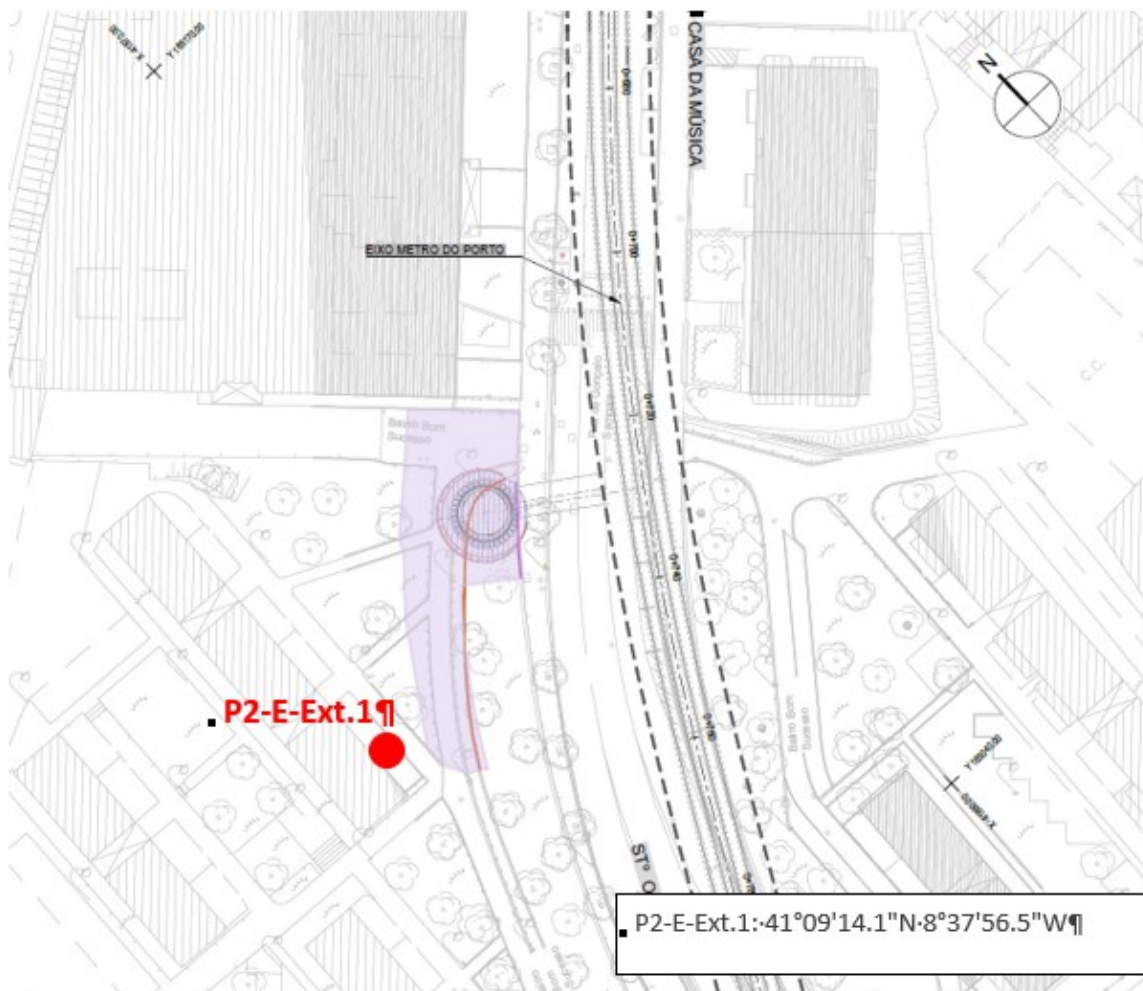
Pontos de monitorização junto aa P2-E (vibrações – construção)
